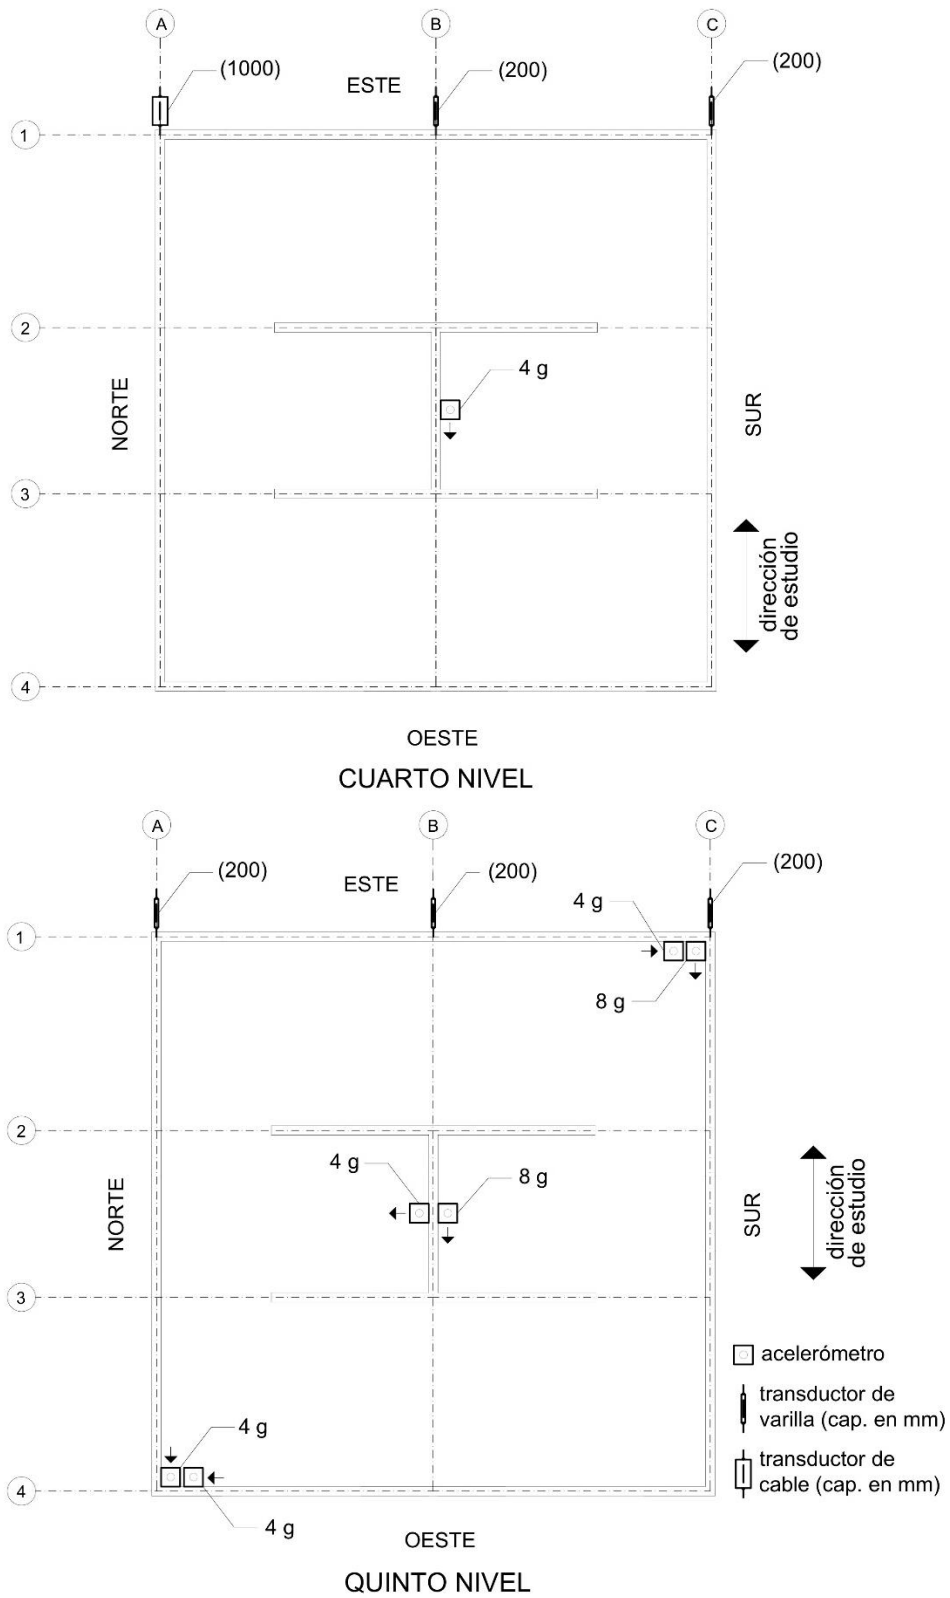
c. Distribución de acelerómetros y transductores de desplazamiento externos en planta
